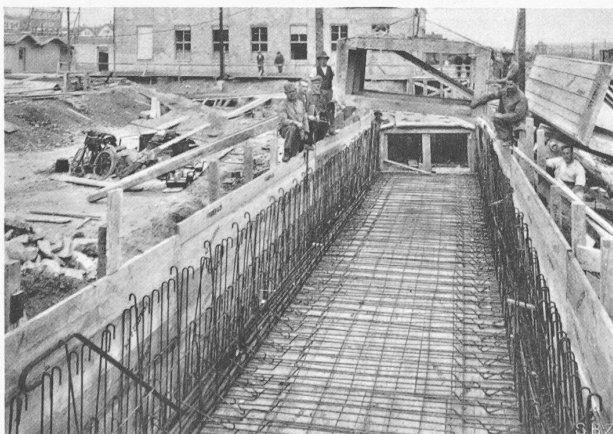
Verbindungstunnel zum Postbureau Hauptbahnhof. Auf 17,5 m Länge freitragend konstruiert, zwecks späterer Unterfahrung durch die hier projektierte Kasernenquai-Unterführung längs der Sihl. 7. Okt. 1929.
